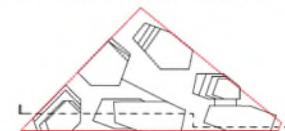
Coupe transversale rue Perrotin (source : PC03.1)
